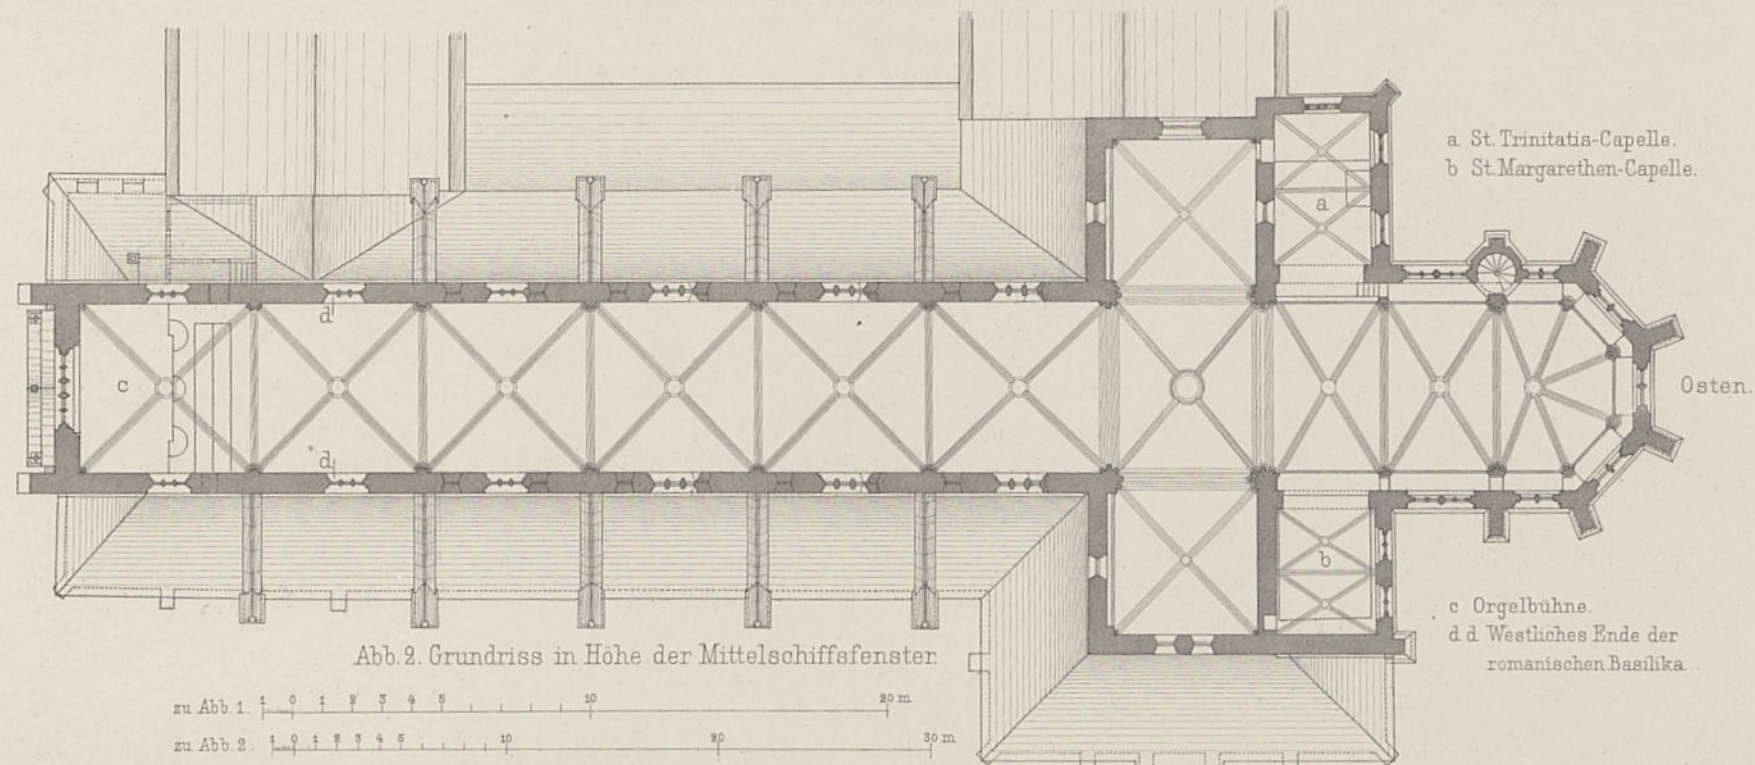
Grundriss in Höhe der Mittelschiffsfenster
